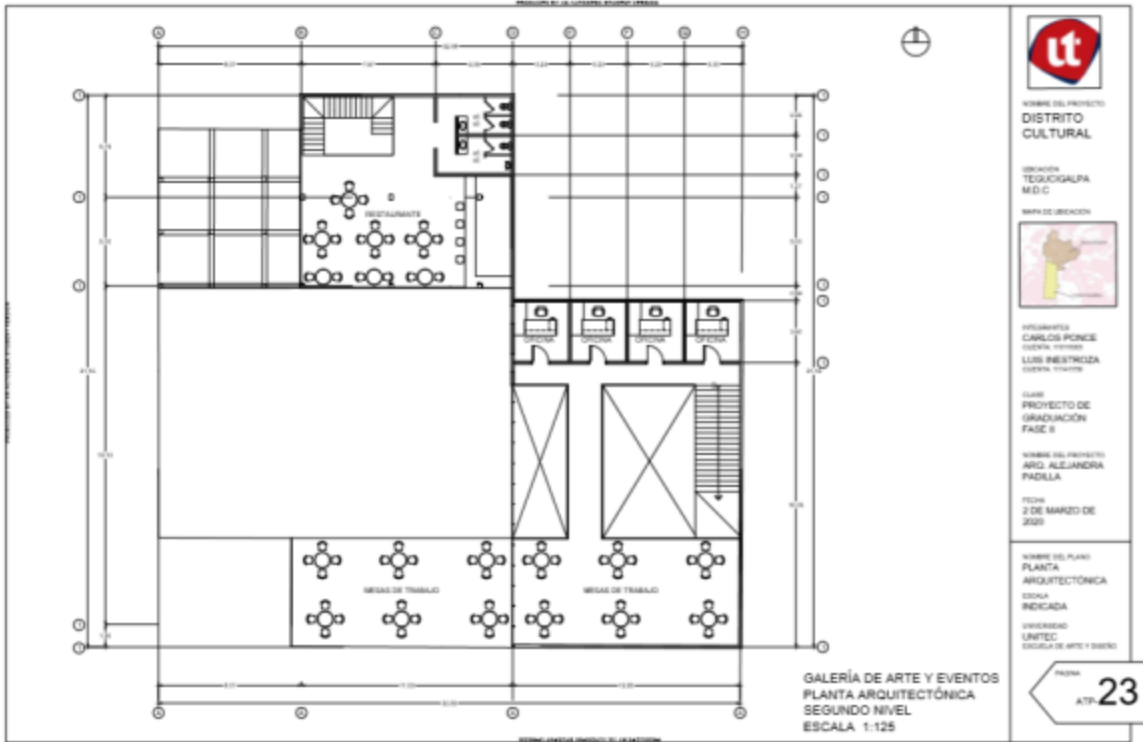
Planta Arquitectónica Galería de Arte y Eventos Segundo Nivel
